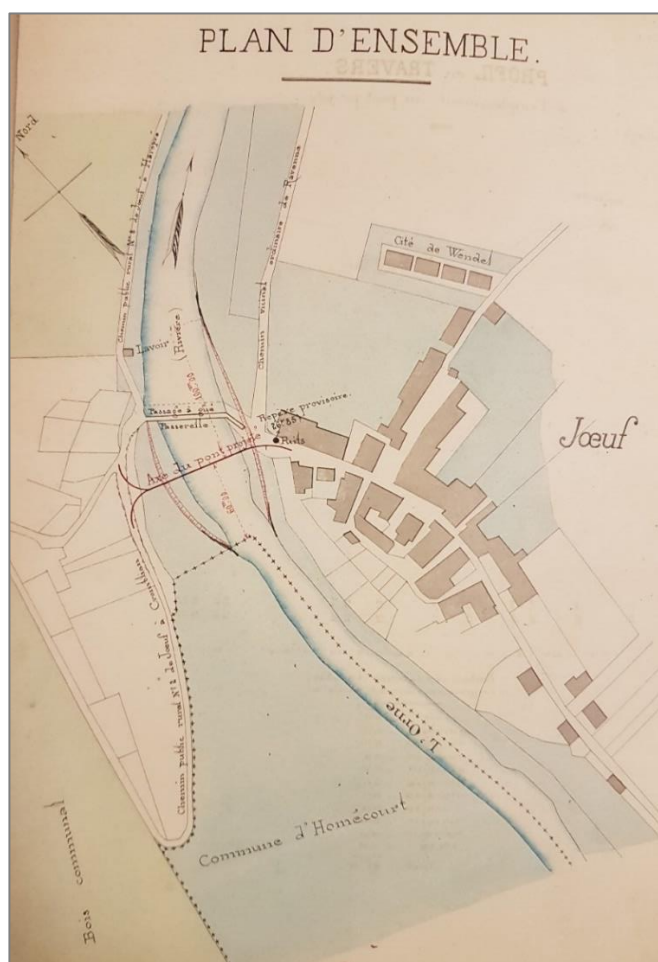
Plan d'ensemble du projet de construction d'un pont en maçonnerie ou en fer sur l'Orne à Joeuf, octobre 1886. (Source : AD 54 – 3S88)
